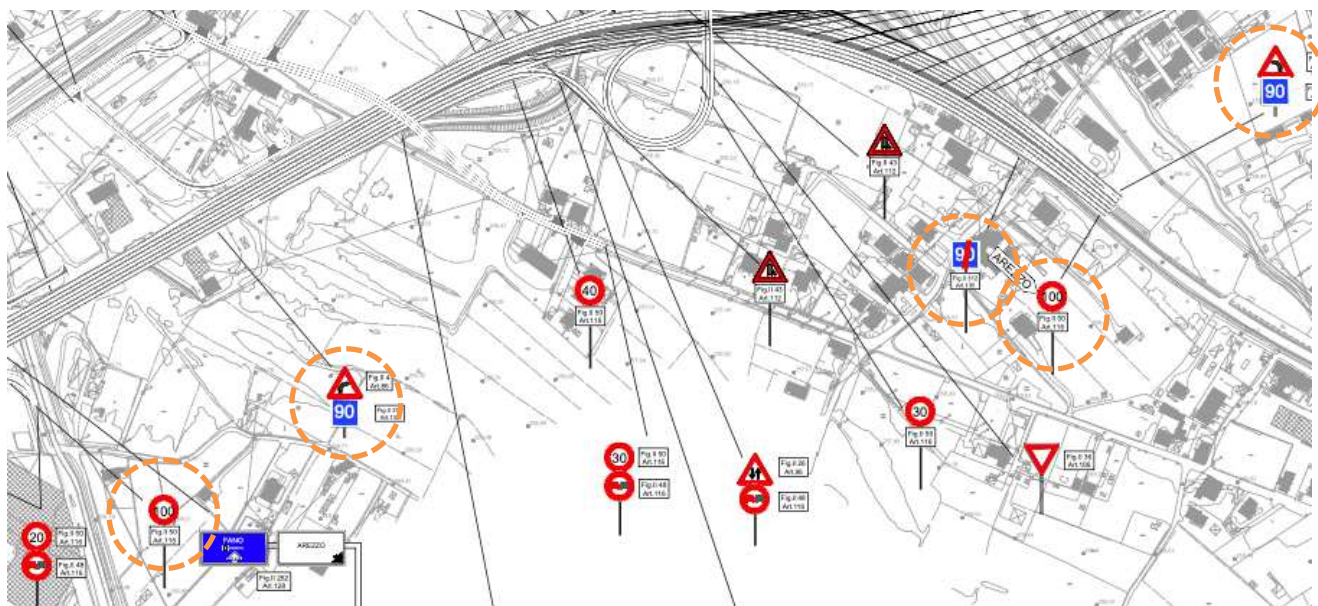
Stralcio planimetrico della curva n. 7 con piano segnaletico
